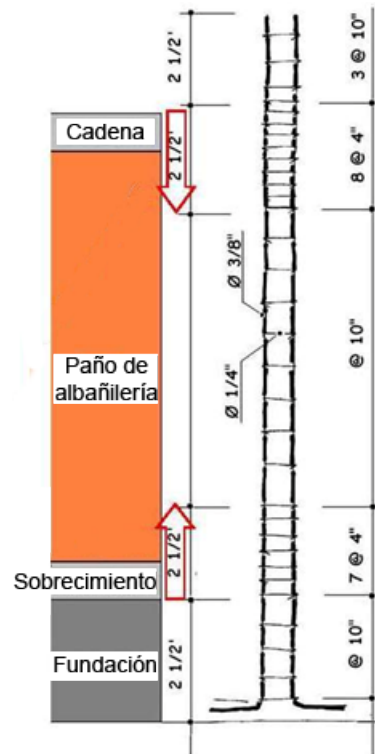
Estribos en las zonas críticas de un pilar (Schacher, 2006)
